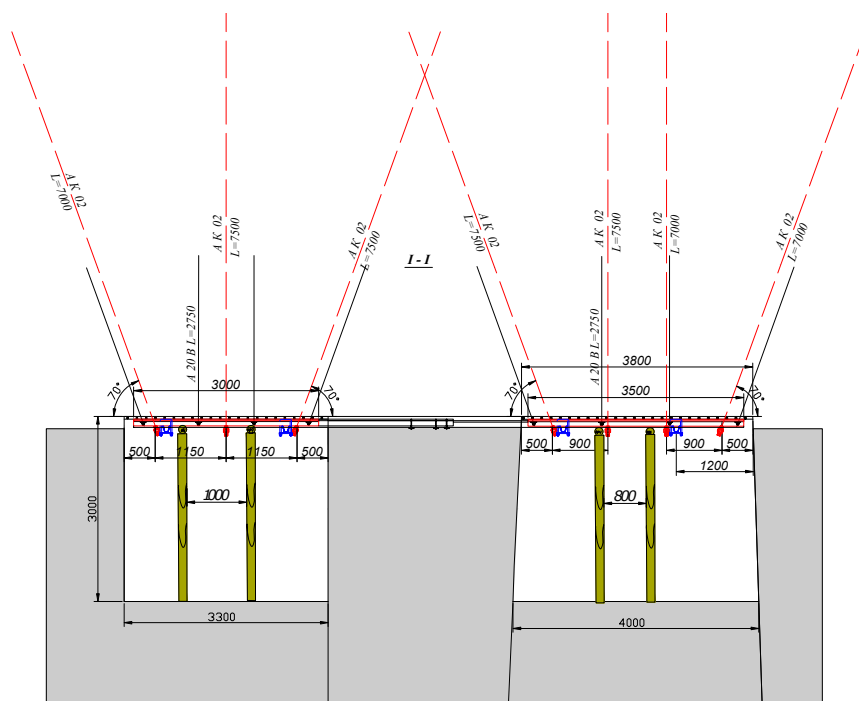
Схема крепления ППДК с двумя демонтакными выработками
